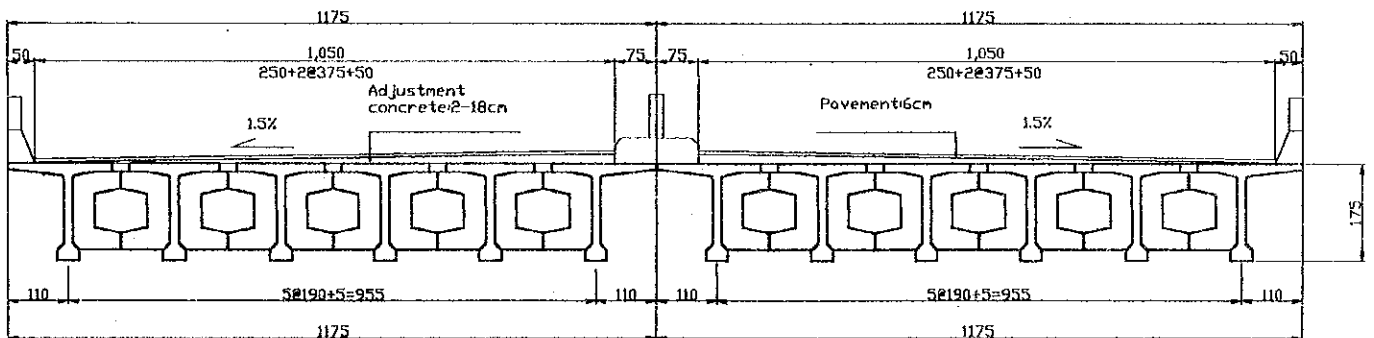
スパン $L_0=40\text{m}$: PCポステンT桁橋の標準断面図
